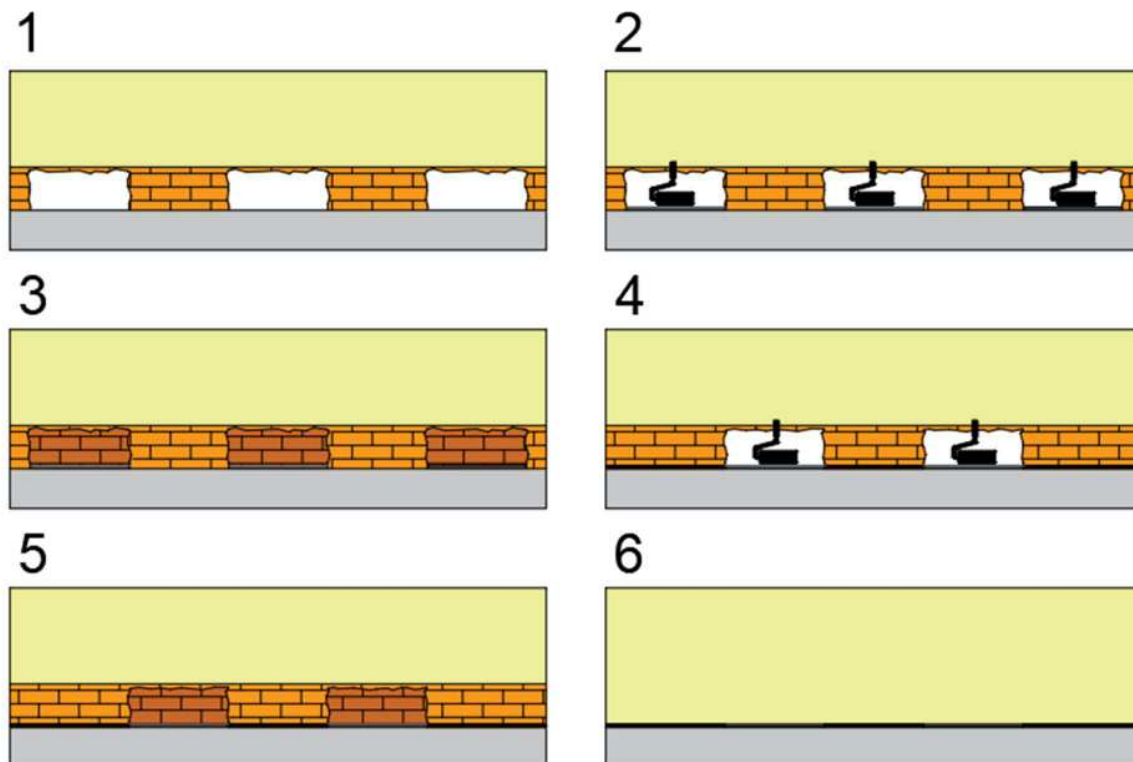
Paredes que deverão receber impermeabilização do baldrame
